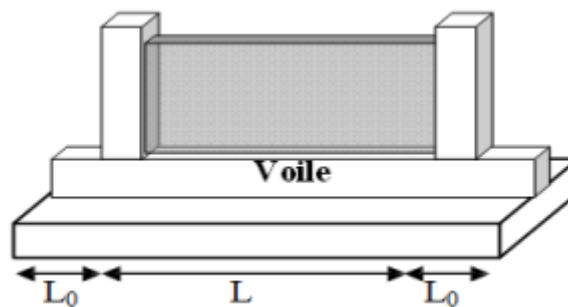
schéma de semelle filante Sous deux poteaux et un voile
